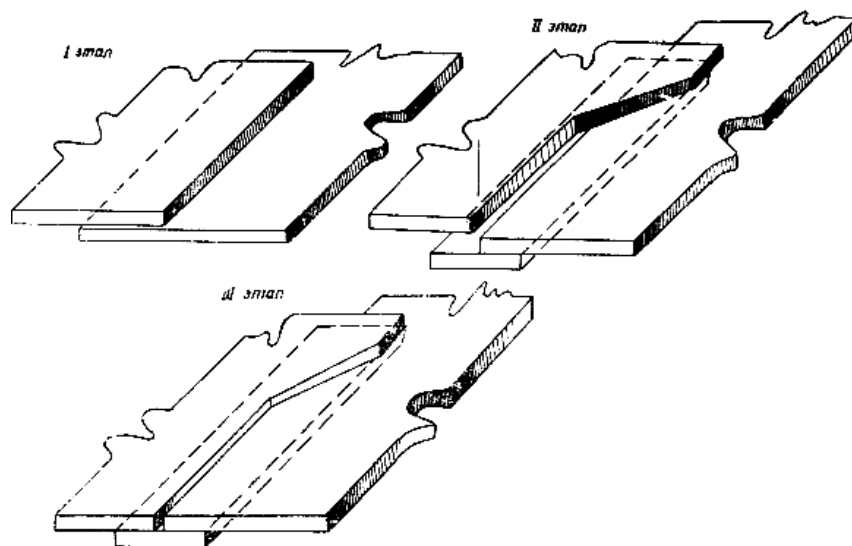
Этапы сборки окраек на подкладке при изготовлении днища вертикального резервуара
